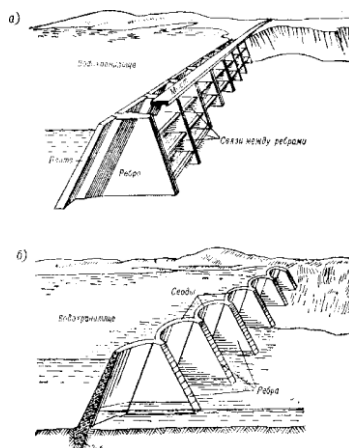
Железобетонные контрфорсные плотины: а – с плоской напорной гранью; б – многоарочная
